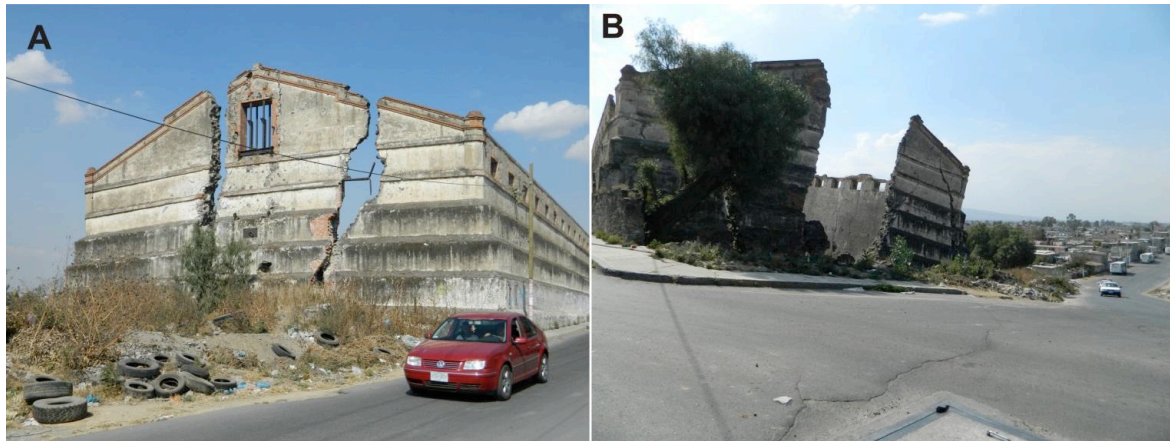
Amplio desarrollo de grietas, que han afectado considerablemente la estructura. A) Parte posterior de la construcción. B) Frente de la construcción, nótese el desnivel altitudinal, que evidencia su localización por encima de la zona lacustre.
